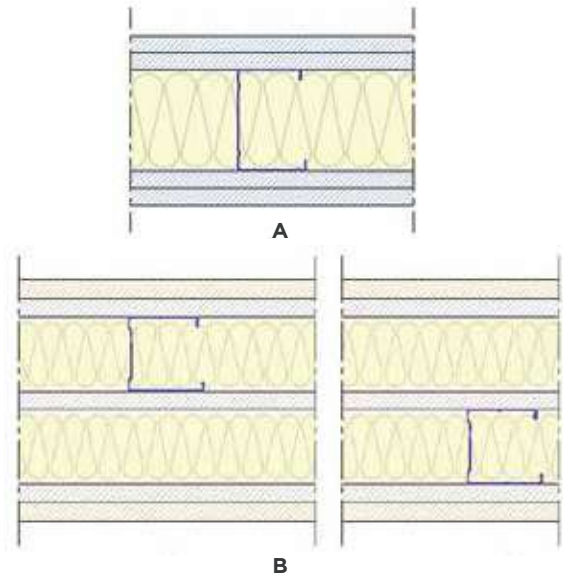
Esempio di pareti leggere in lastre di gesso rivestito, singola struttura (A) e doppia struttura (B).
